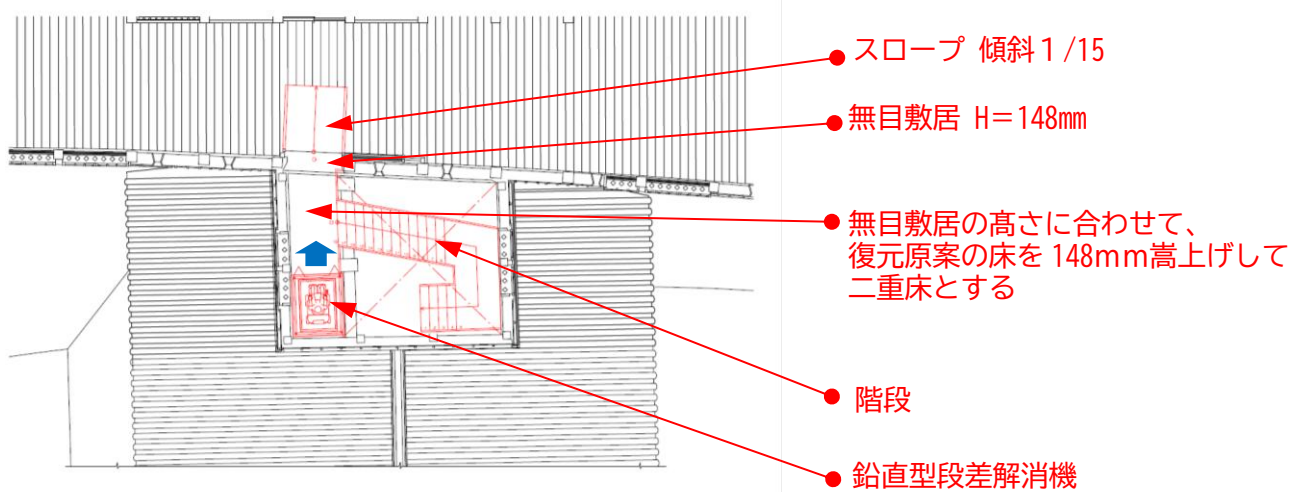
南廊下2階平面図 (南廊下便益施設案)
